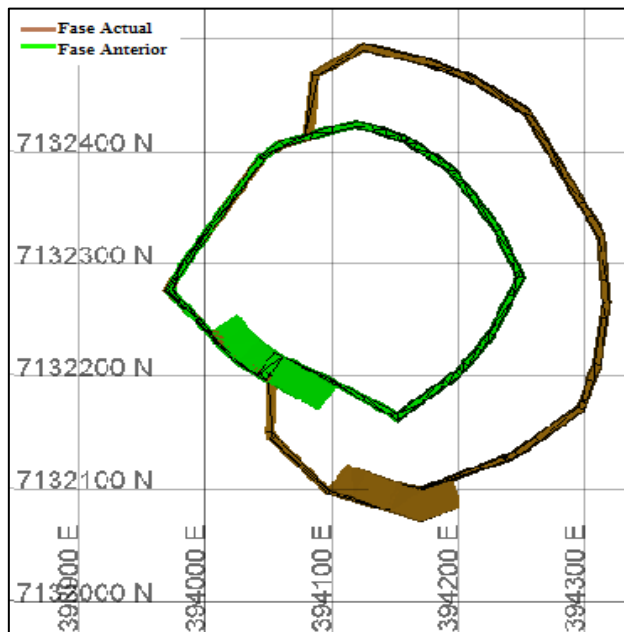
LPNB Fase 2 - Vista en sección - Planta banco 1120
